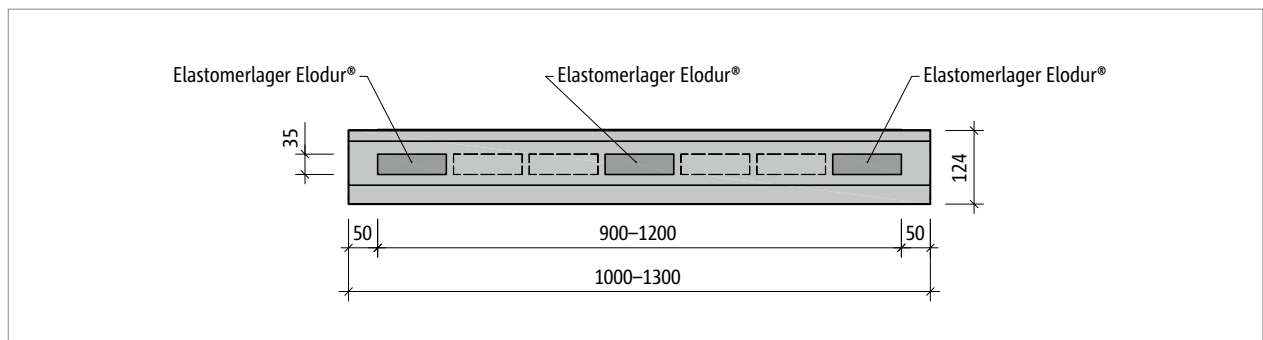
Schöck Tronsole® Typ F: Grundriss
